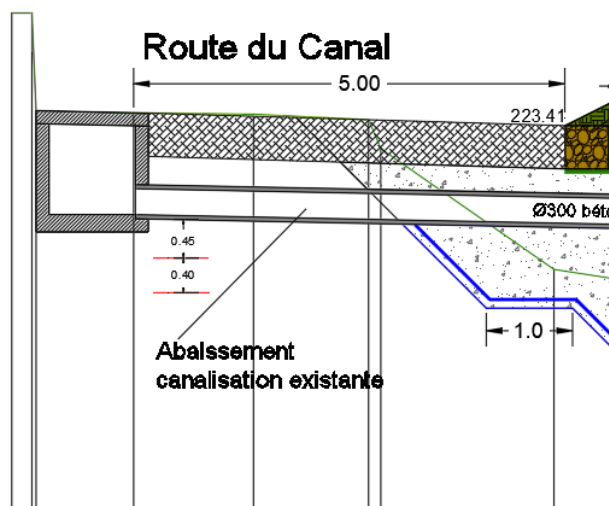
Position de la futur conduite d'assainissement en rouge par rapport aux travaux
